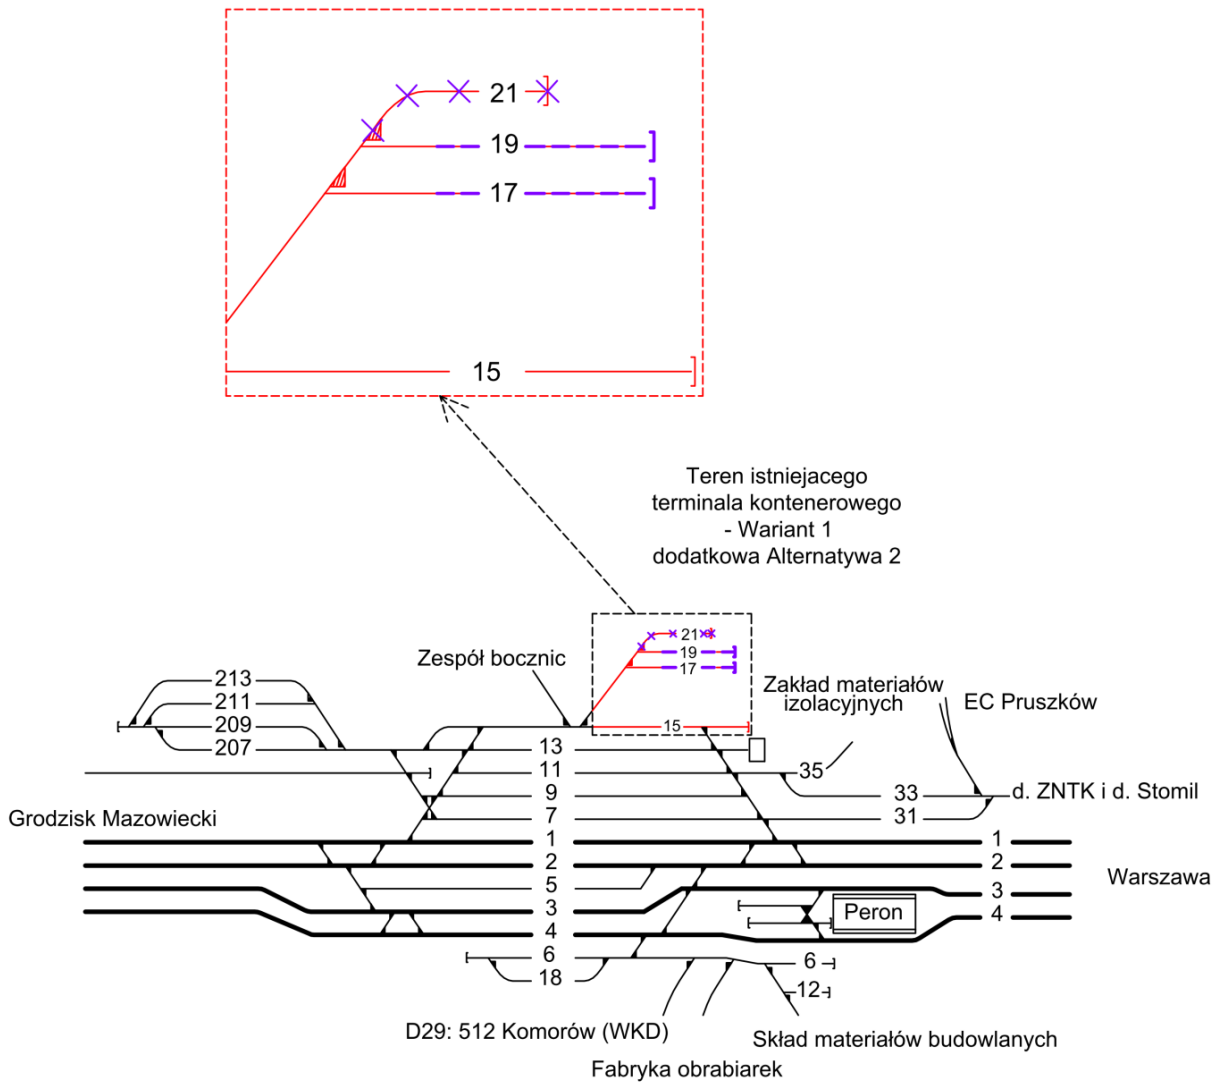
Schemat terminala – Alternatywa 2 wariantu 1
